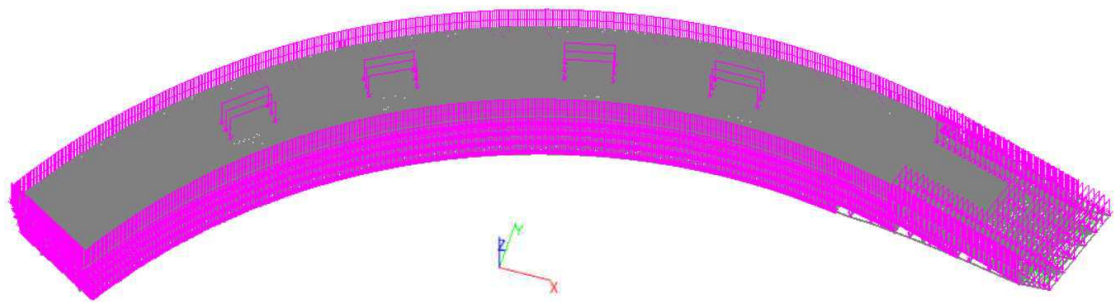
Нагрузка от веса наружных ограждающих конструкций
